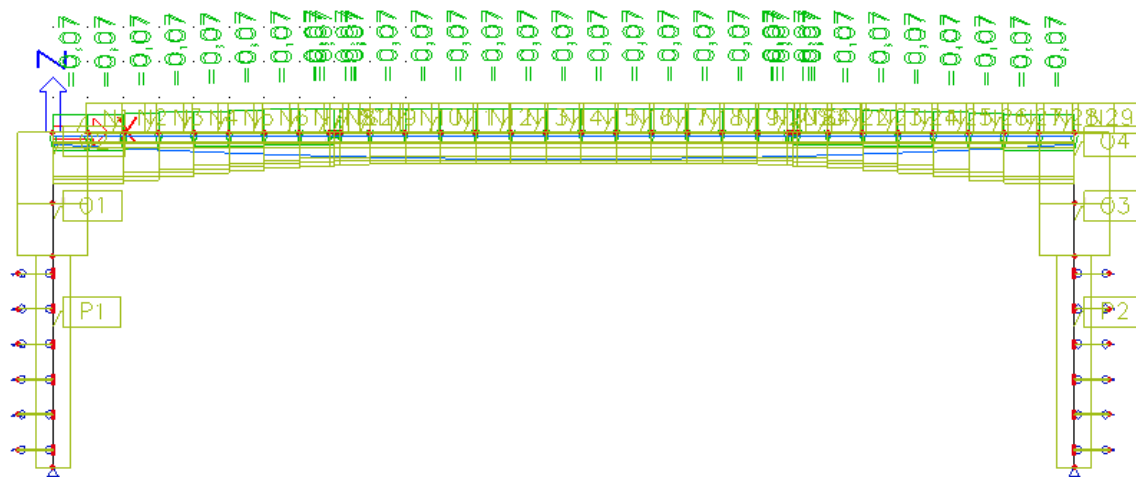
11. Fáze výstavby – betonáž říms, čas 70. den
